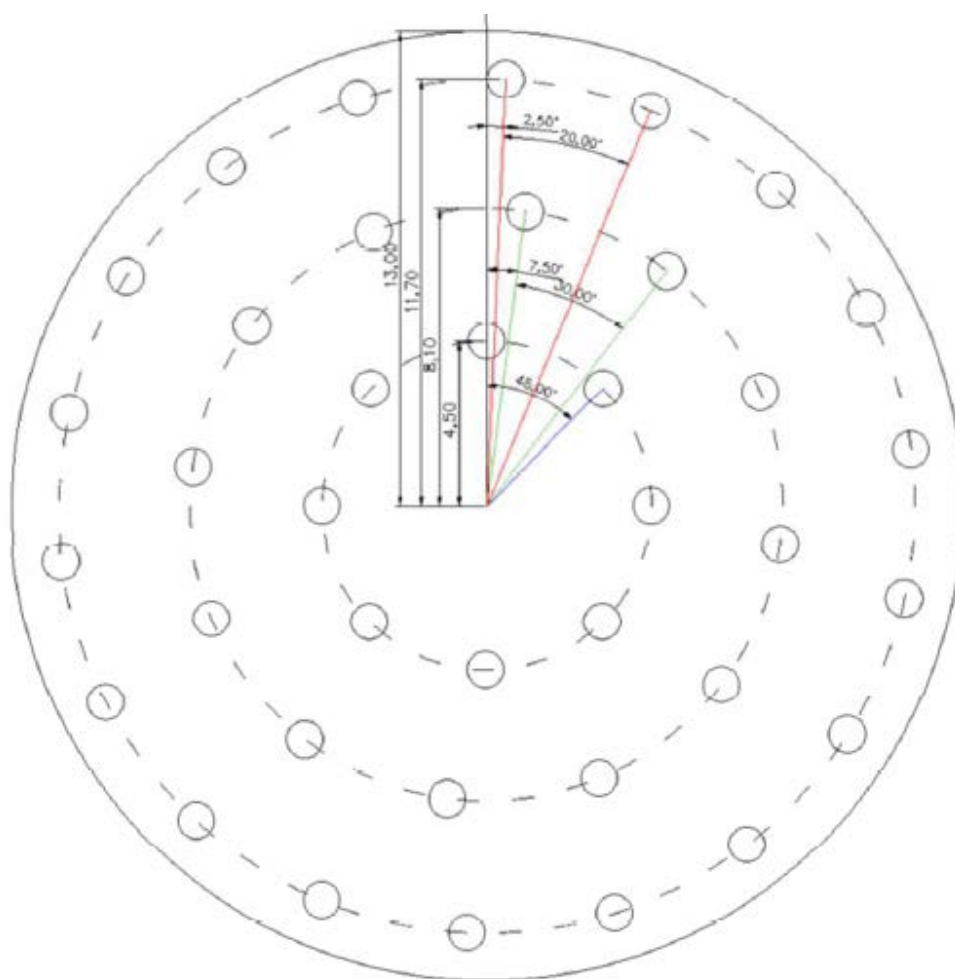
Pianta del Plinto di fondazione degli aerogeneratori con disposizione radiale dei 38 pali trivellati
